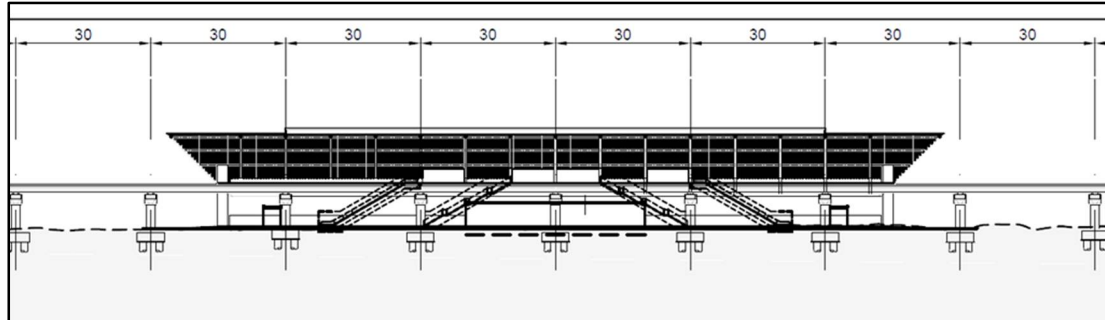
Perfil longitudinal del viaducto elevado en la zona de la Estación E11
